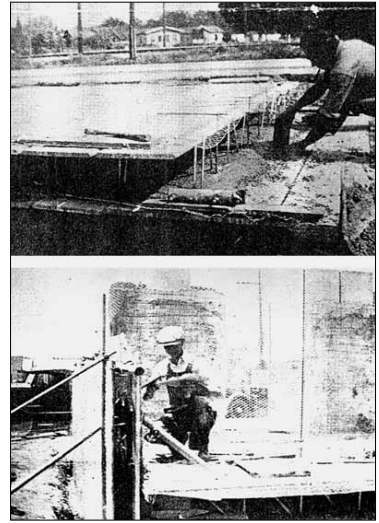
가렛 건설공법 (Garrett construction system) 과정
